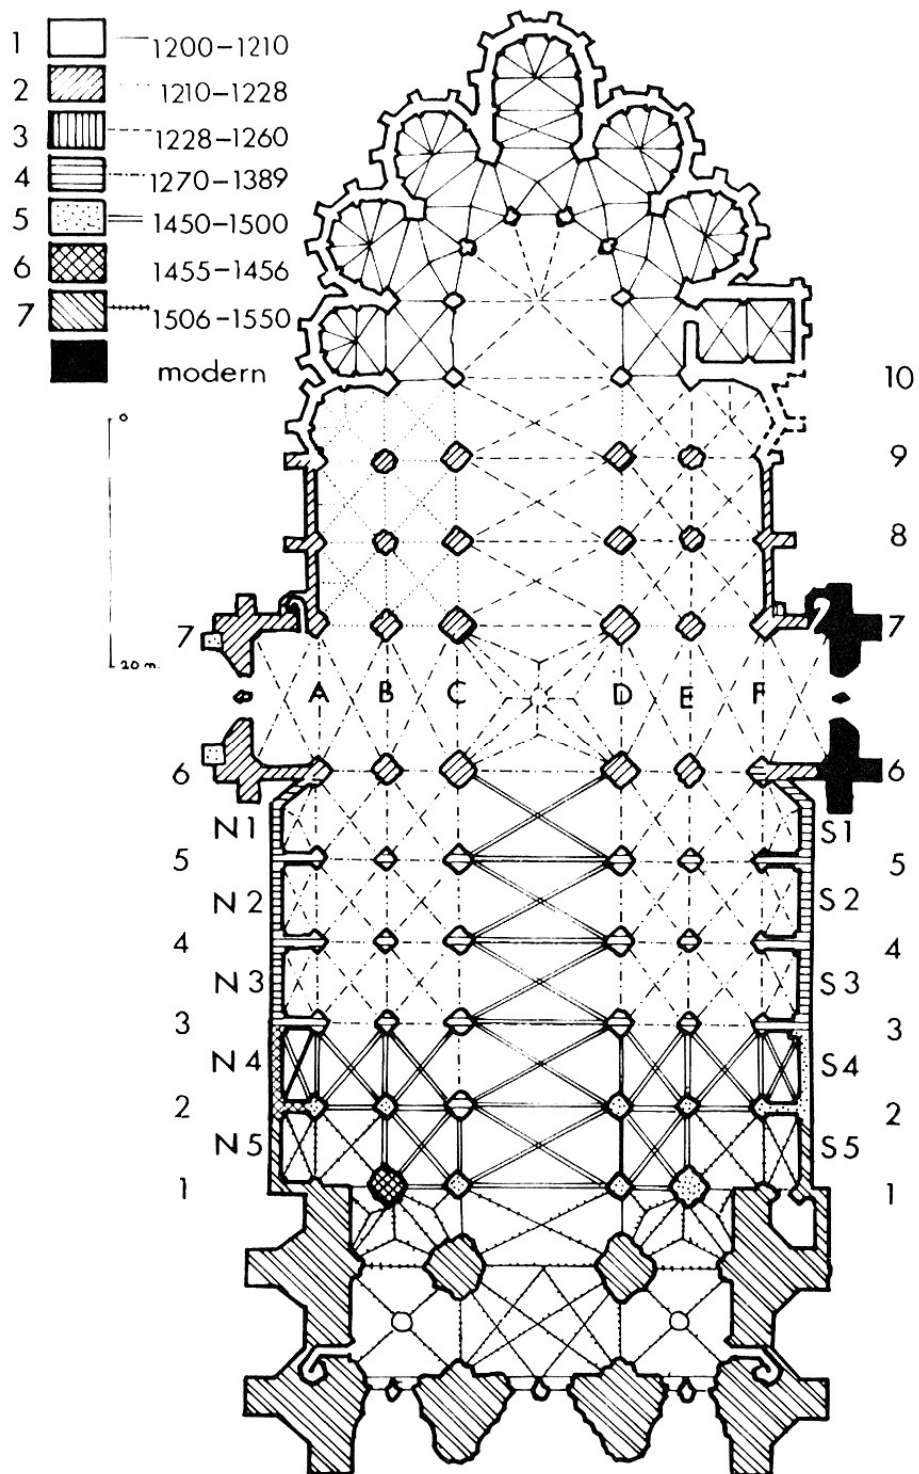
Plan de la cathédrale de Troyes avec grille de référence, d'après Murray⁶⁸¹.
